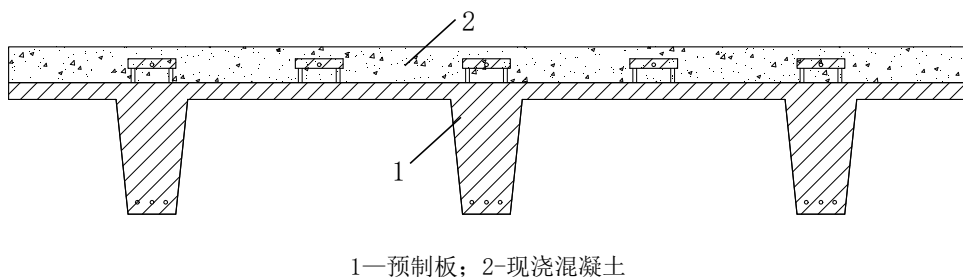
高性能混凝土肋混凝土密肋预应力叠合楼板
